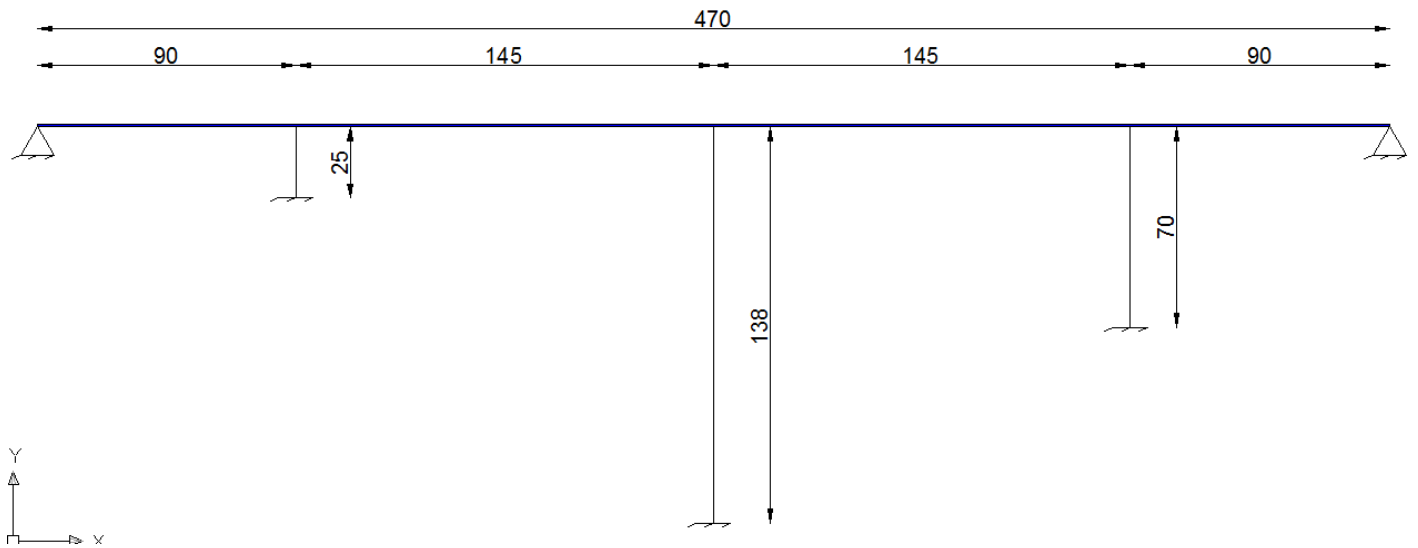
d Longitud total y altura de pilas del puente tipo. Cotas en metros.
